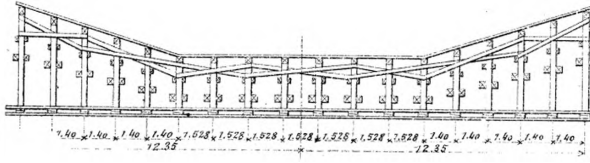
Coupe suivant l'axe du canal (Echelle 1/200)
